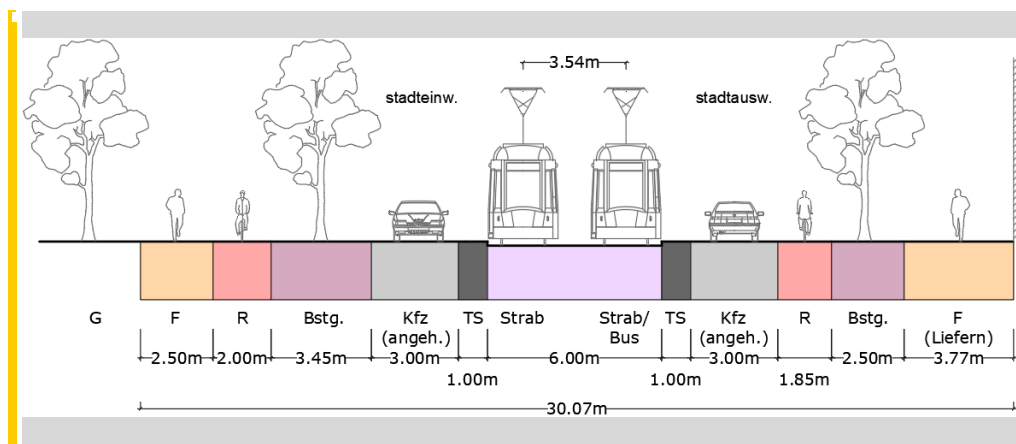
Haltestelle Kastanienstraße, Alternativenprüfung Baumerhalt
